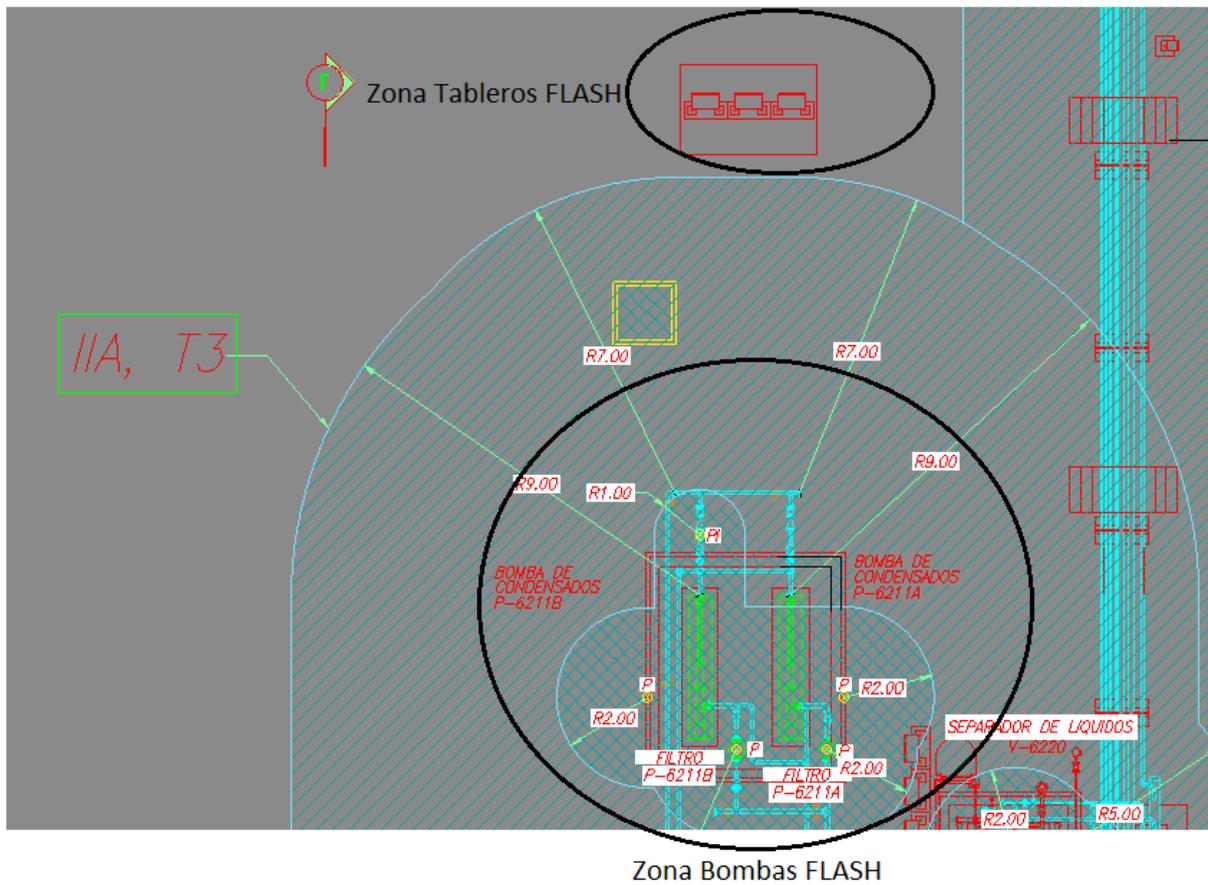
Plano áreas clasificadas zona TK FLASH
